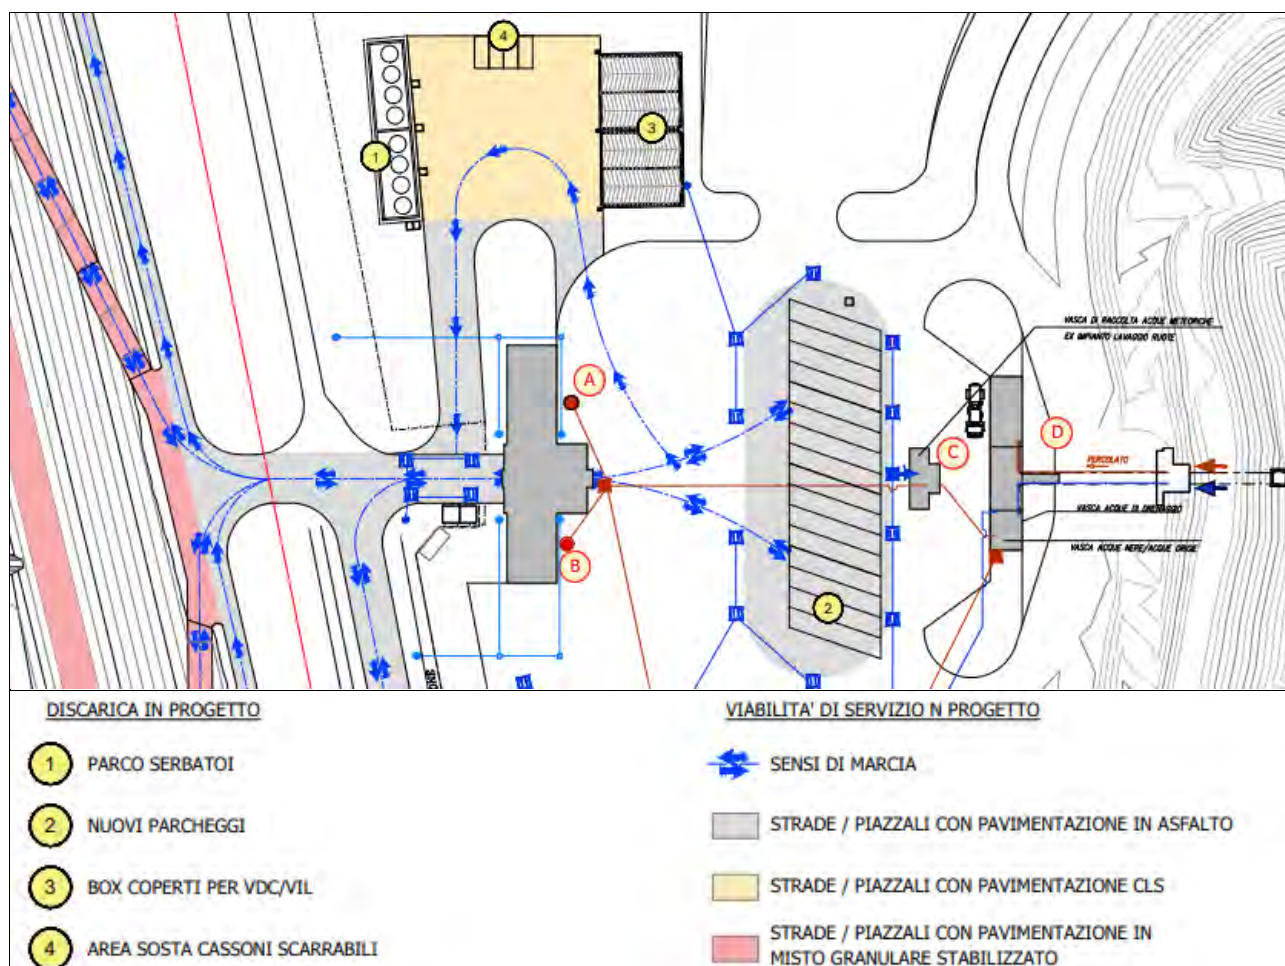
Dettaglio opere in progetto nell'area del Primo Stralcio
